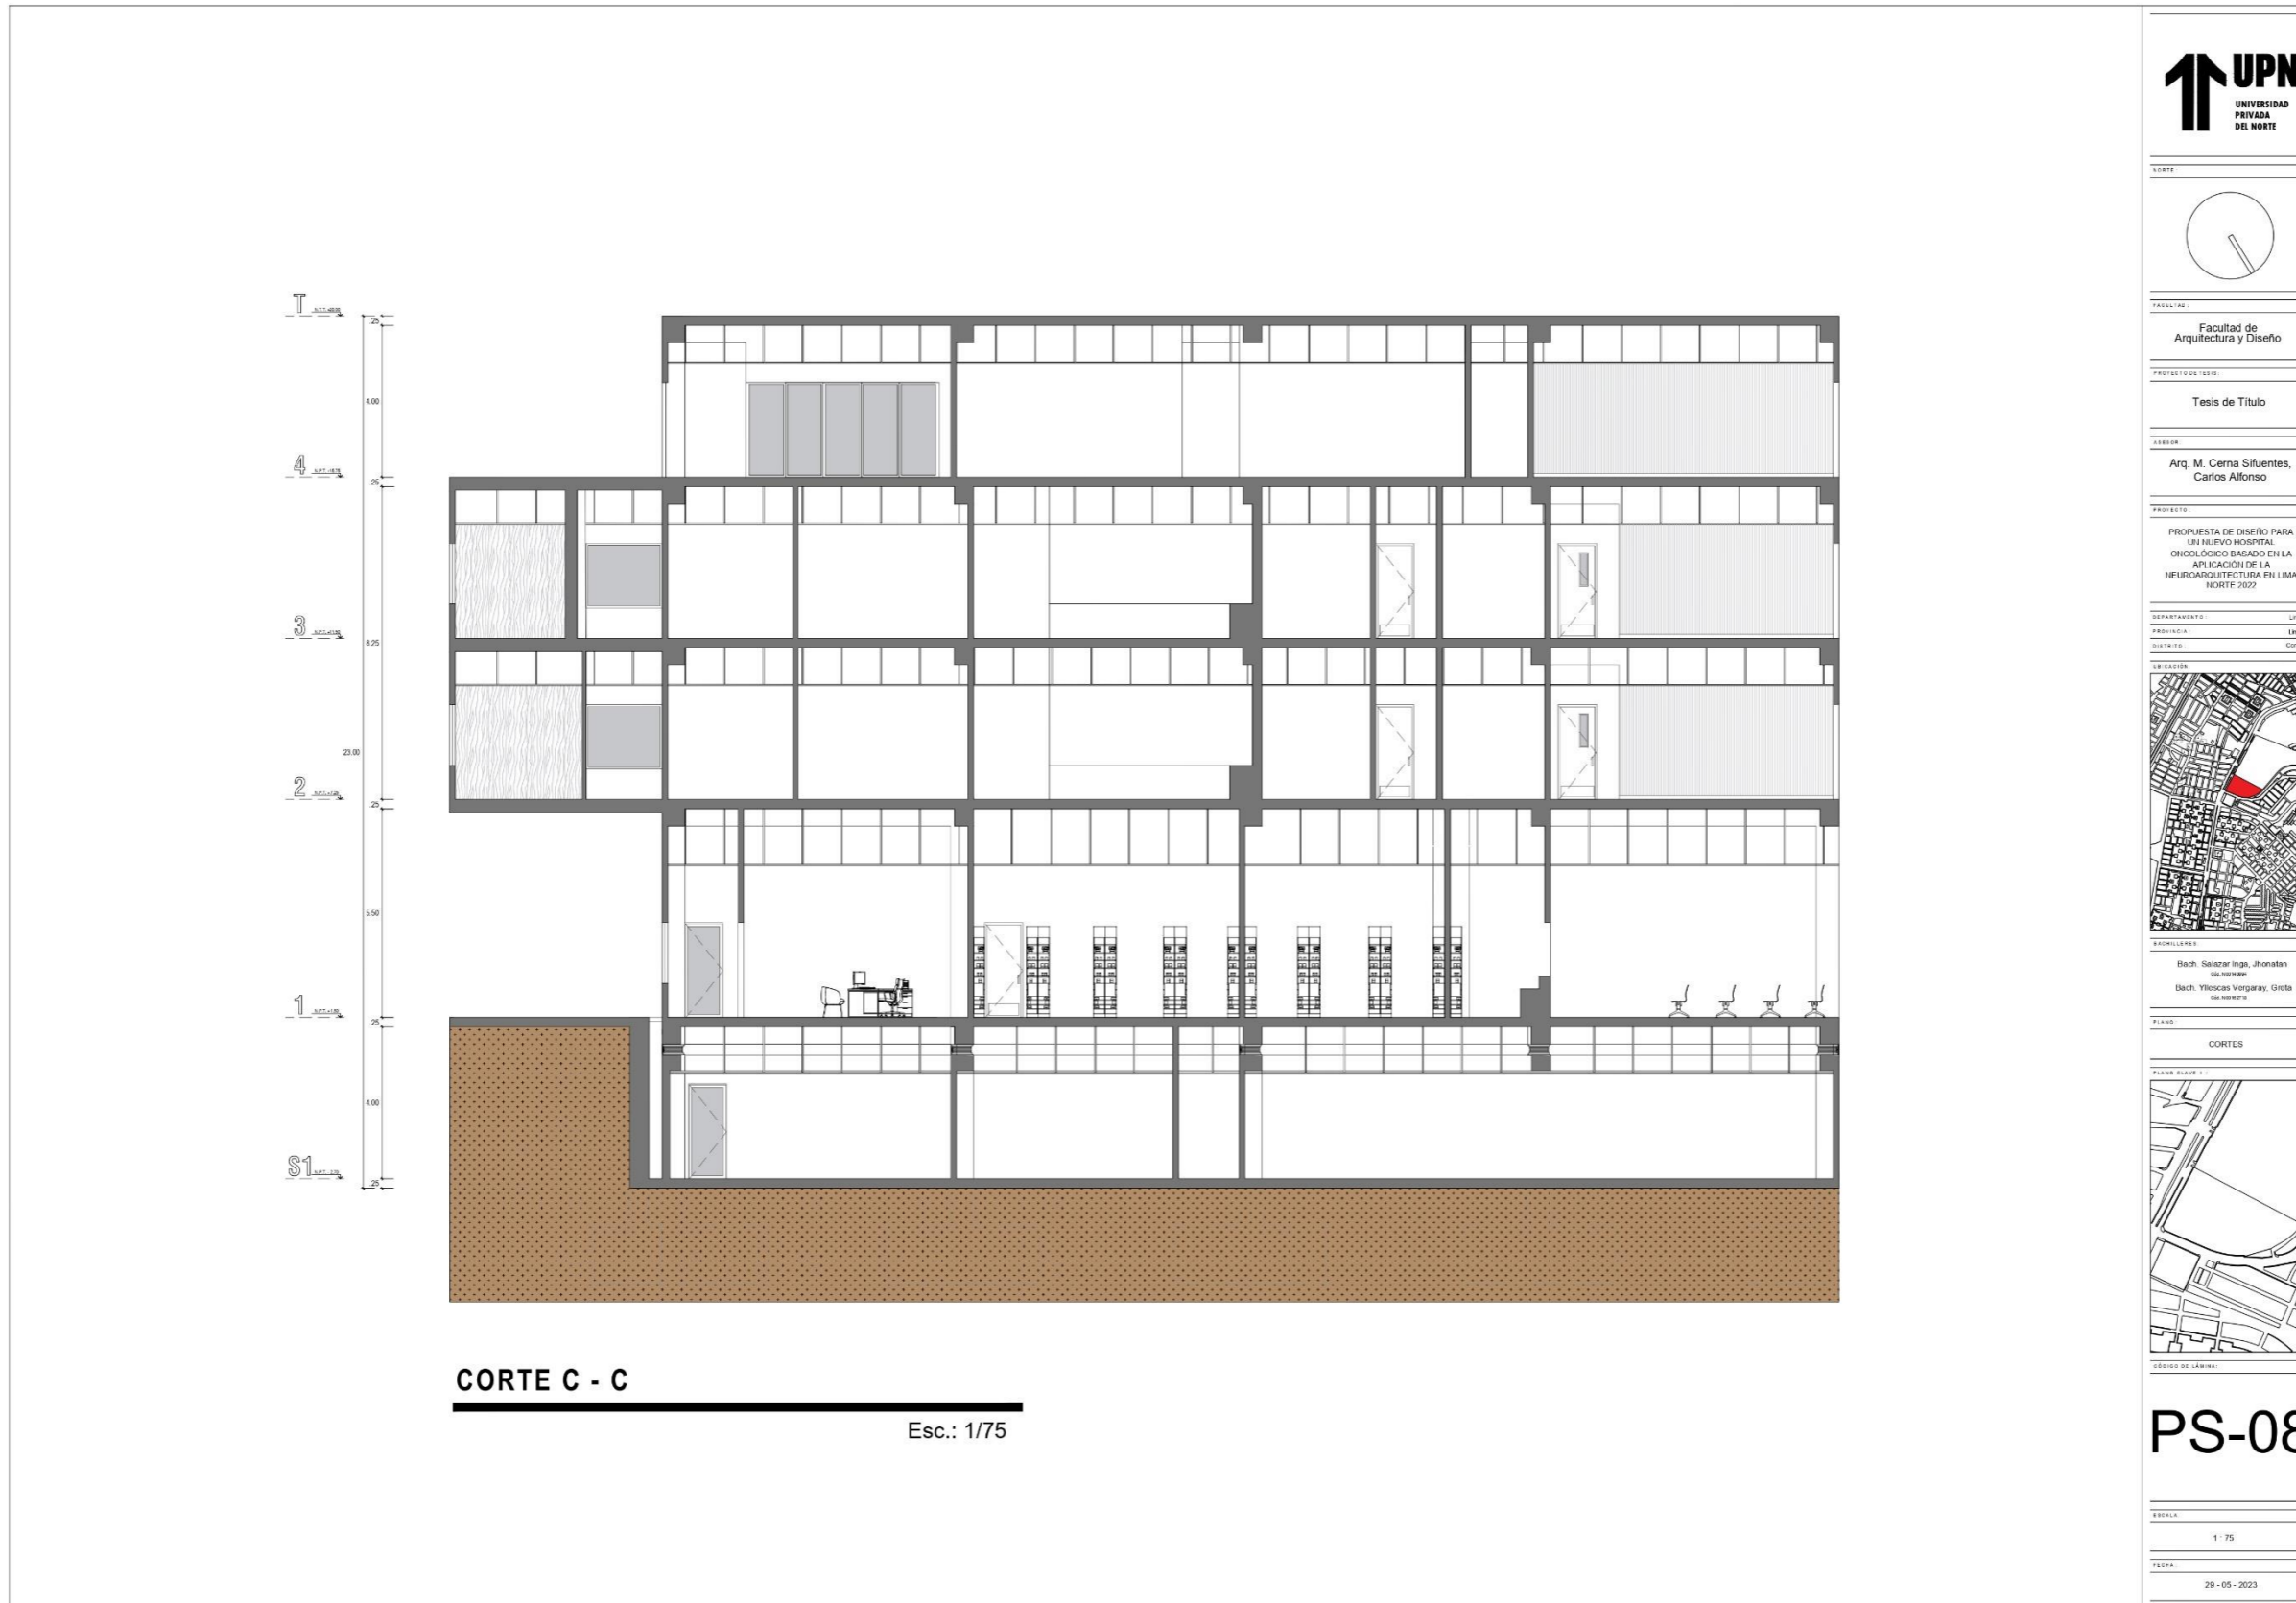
Arquitectura – Cortes N°3 del sector cuadrante Esc: 1/75 (Fuente: Elaboración propia de los coautores)
